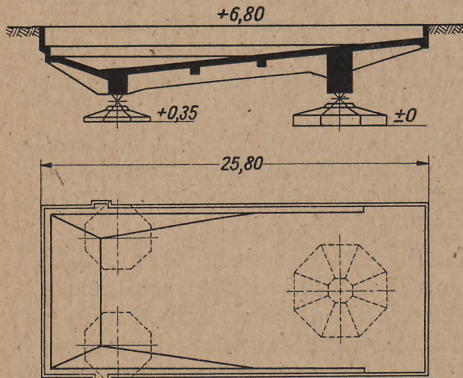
Dreipunkt-lagerung eines Schwimmbeckens
